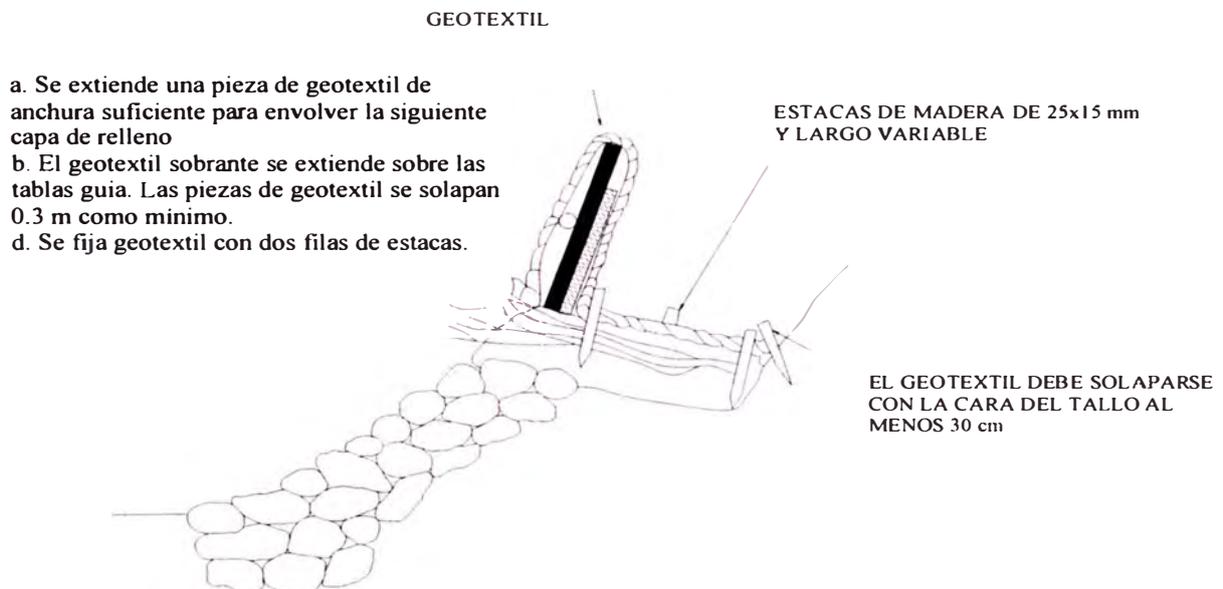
(c): Estructura de tierra reforzada – Proceso Constructivo
